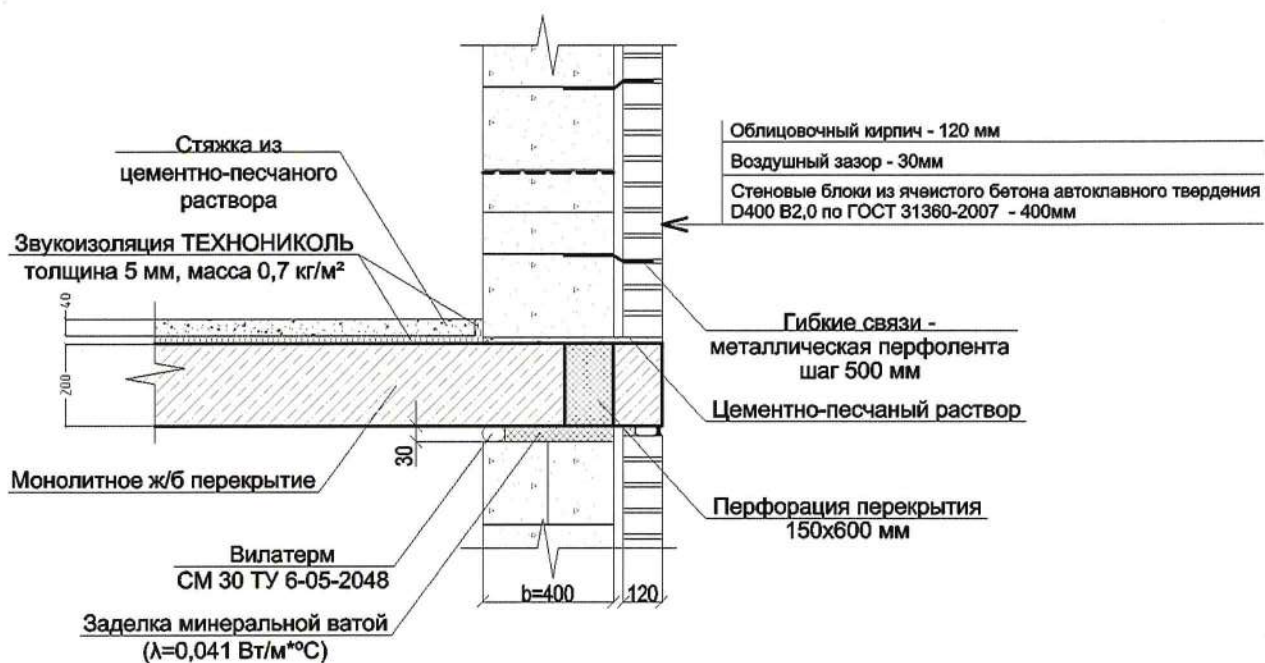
Чертеж плиты перекрытия с облицовкой кирпичом
